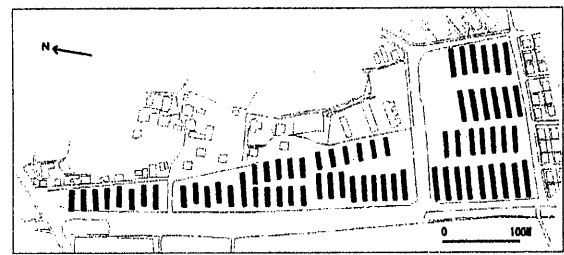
(建替前) 中庄団地住棟配置図 1:10000
